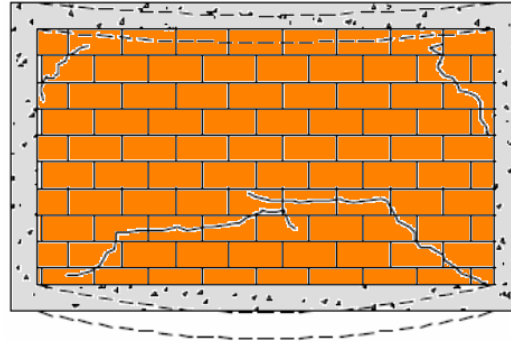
Flecha da viga inferior é maior que a da viga superior – a abertura de fissuras desse tipo é grande, geralmente ultrapassa 1 mm (adaptada de Pfeffermann, 1968).
